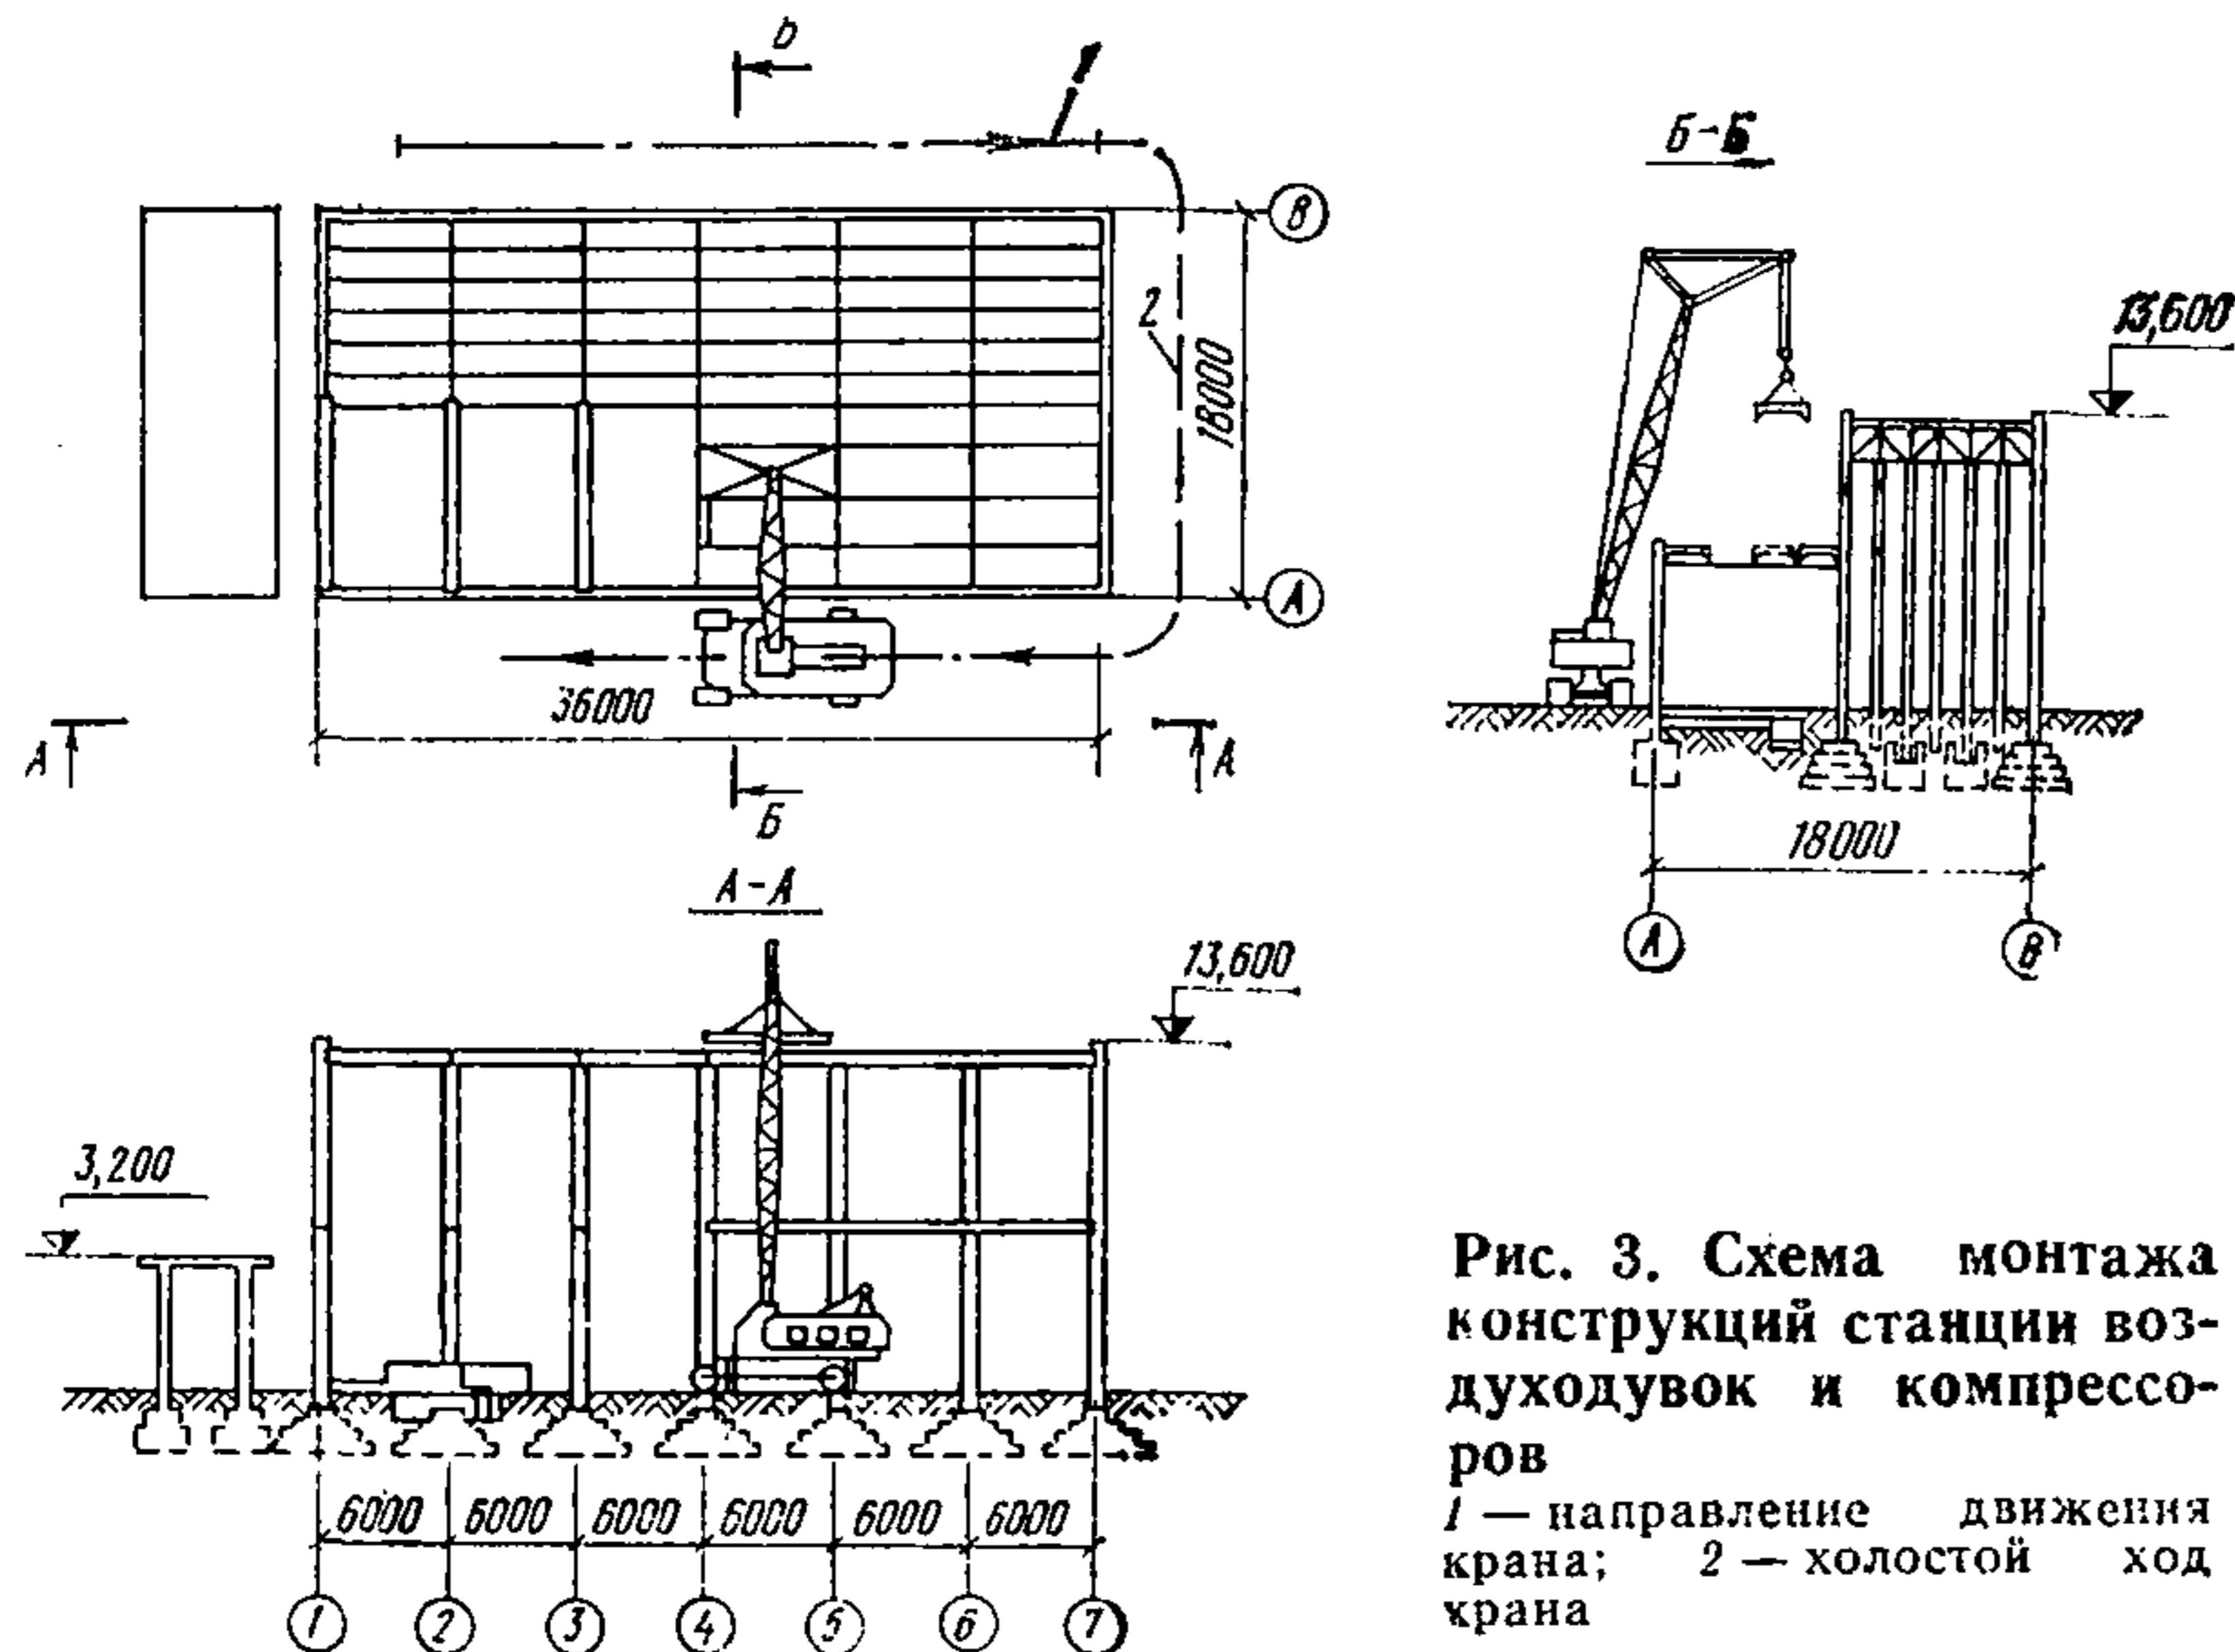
Схема монтажа конструкций станции воздуховодов и компрессоров
